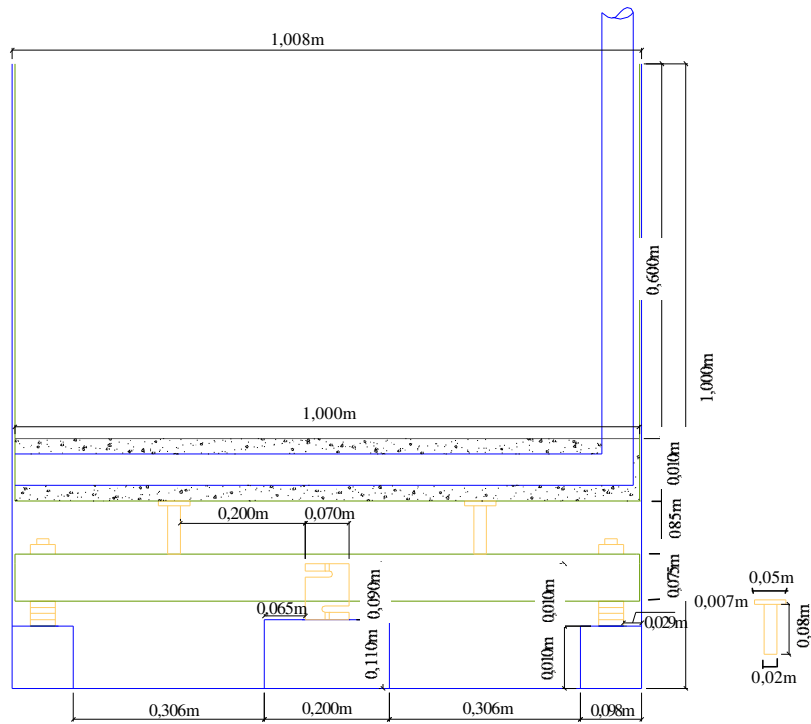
Corte transversal do esquema de instalação do lisímetro de pesagem.
